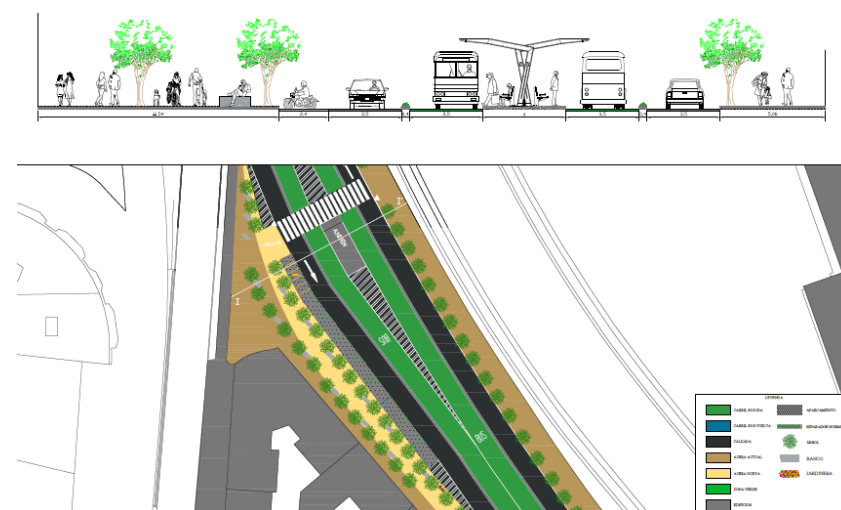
Planta y sección de la calle Primo Rivera.
